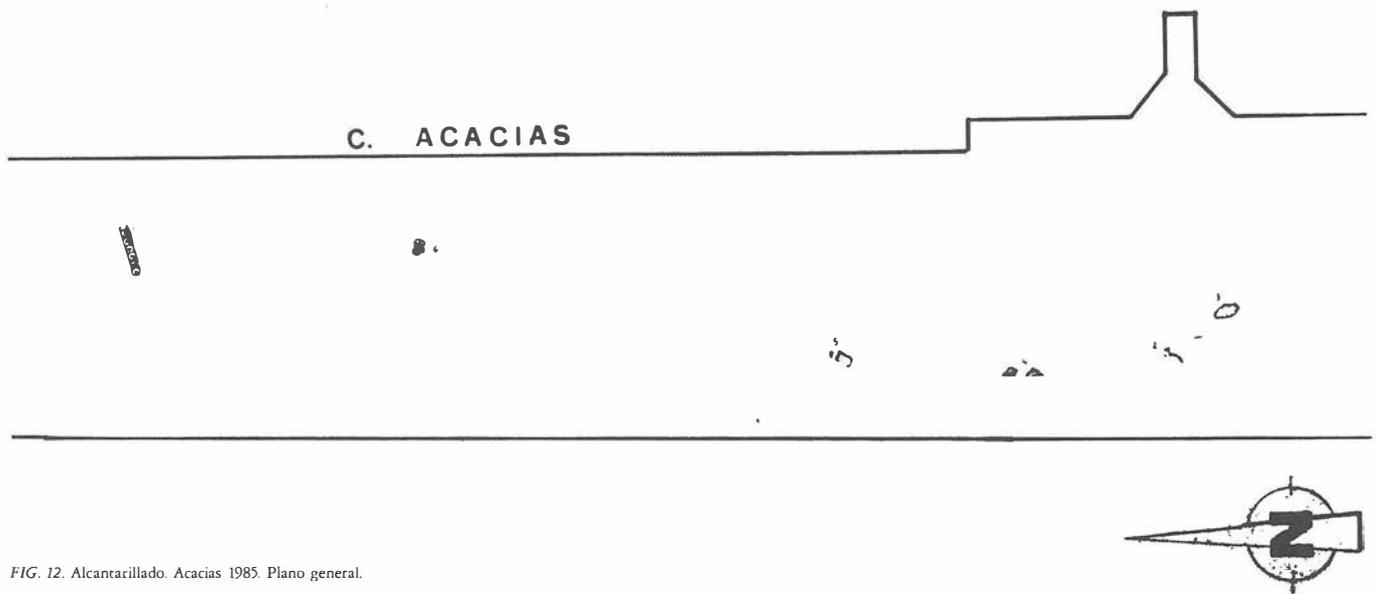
Alcantarillado. Acacias 1985. Plano general.
